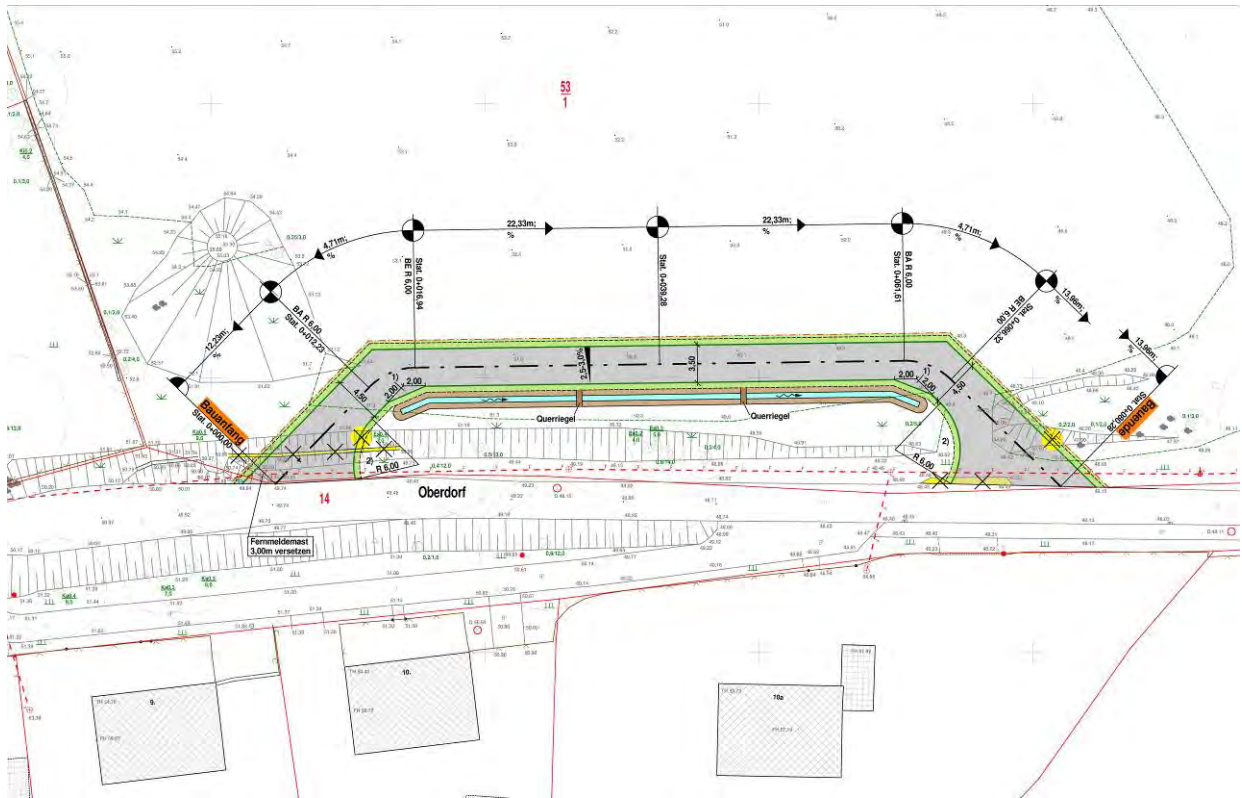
Lageplan mit dem geschützten Baum, der beseitigt werden soll (gelber Kreis links, MINKE 2019)
